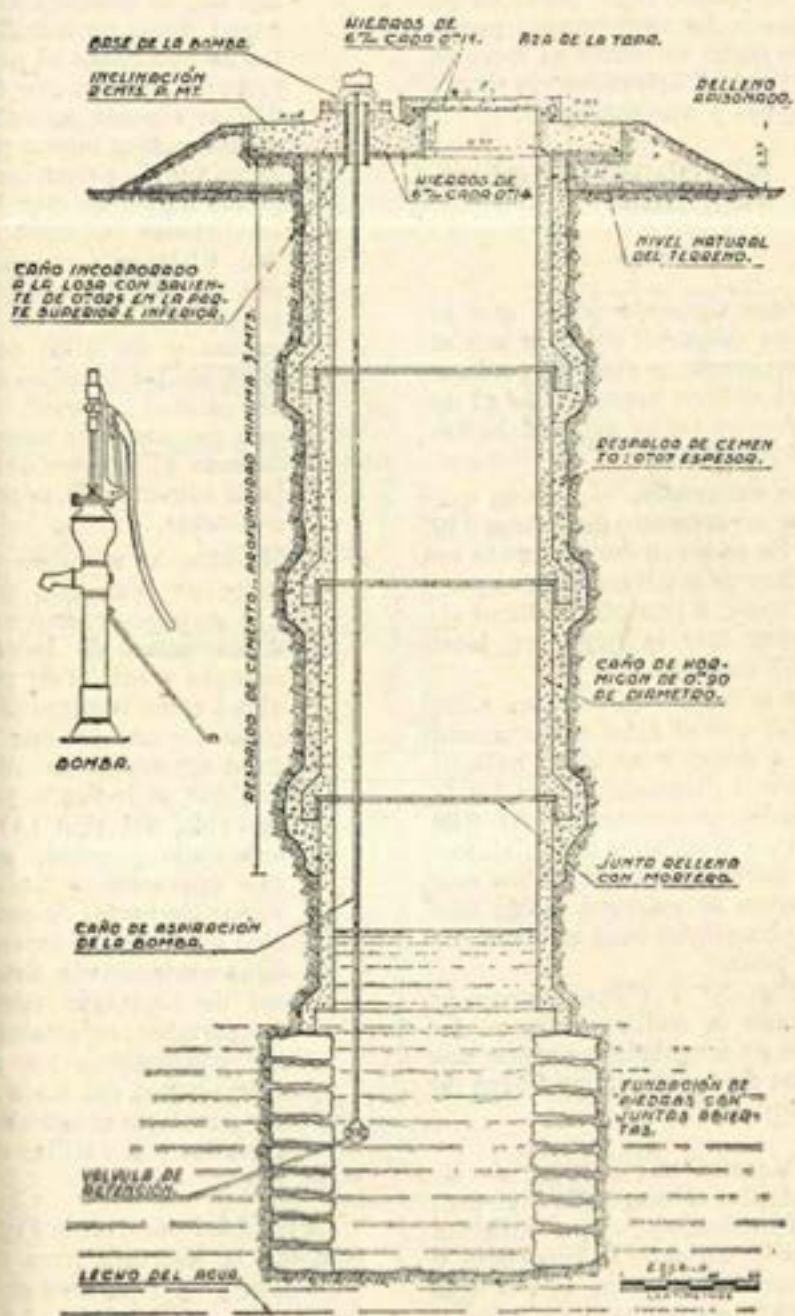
Pozo excavado revestido con caño de hormigón.
